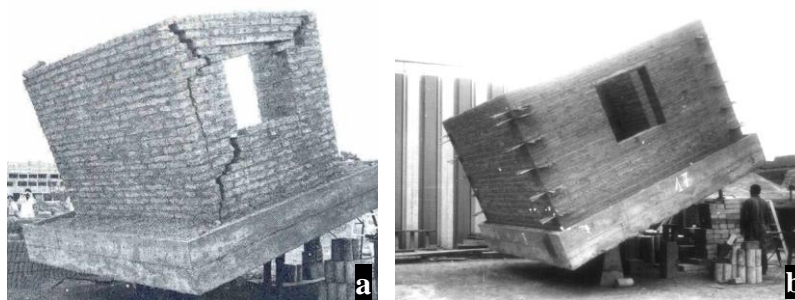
Módulo não reforçado (a) e reforçado (b) no primeiro ensaio estático em 1973. [28]
